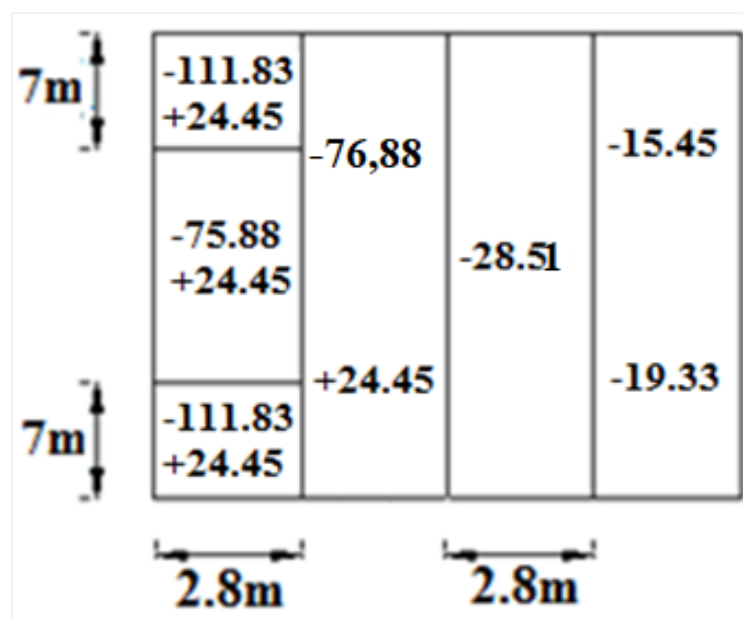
Pression du vent N°2 sur la toiture (Long-pan)
